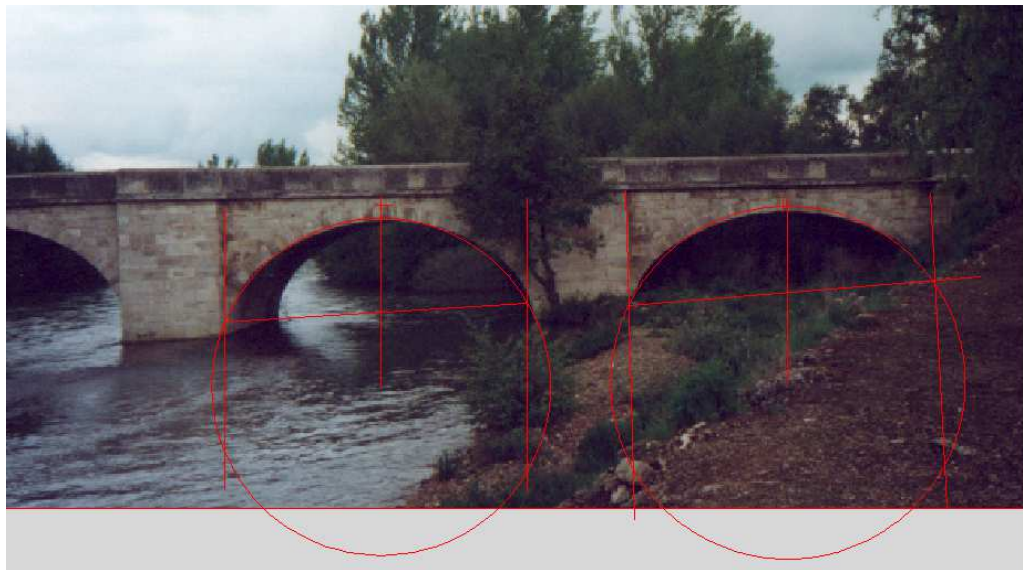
Foto de arcos ligeramente rebajados en puente en Villoldo.
